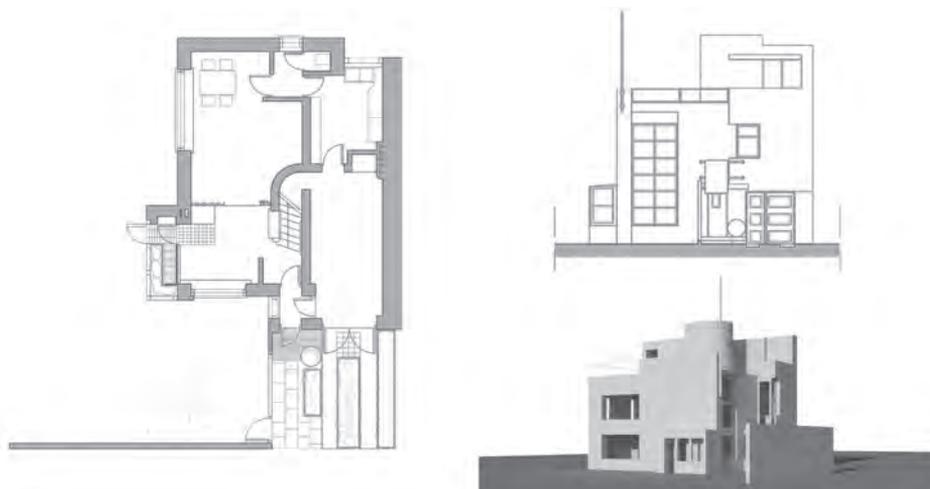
Ridisegni della pianta del piano terra, del prospetto principale e prospettiva.
